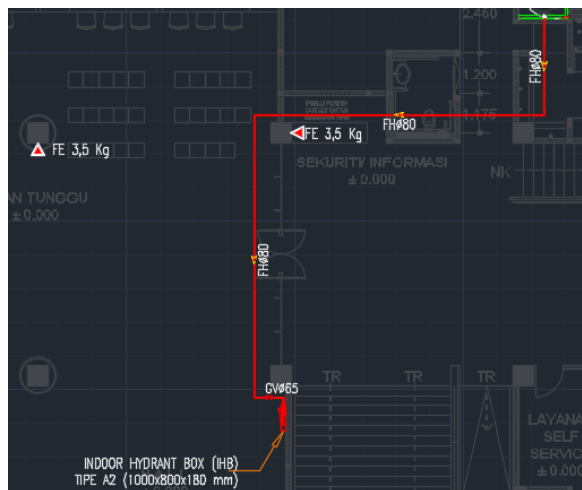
Denah Arsitektur Pemasangan IHB pada Lantai Dasar
